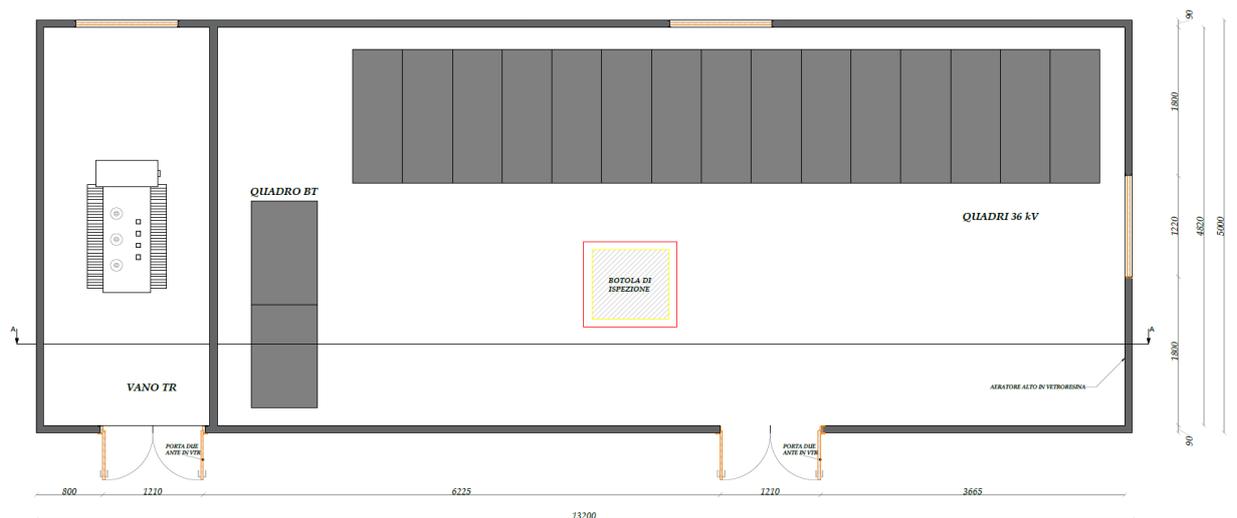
Pianta della cabina di raccolta CR3 36 kV.
